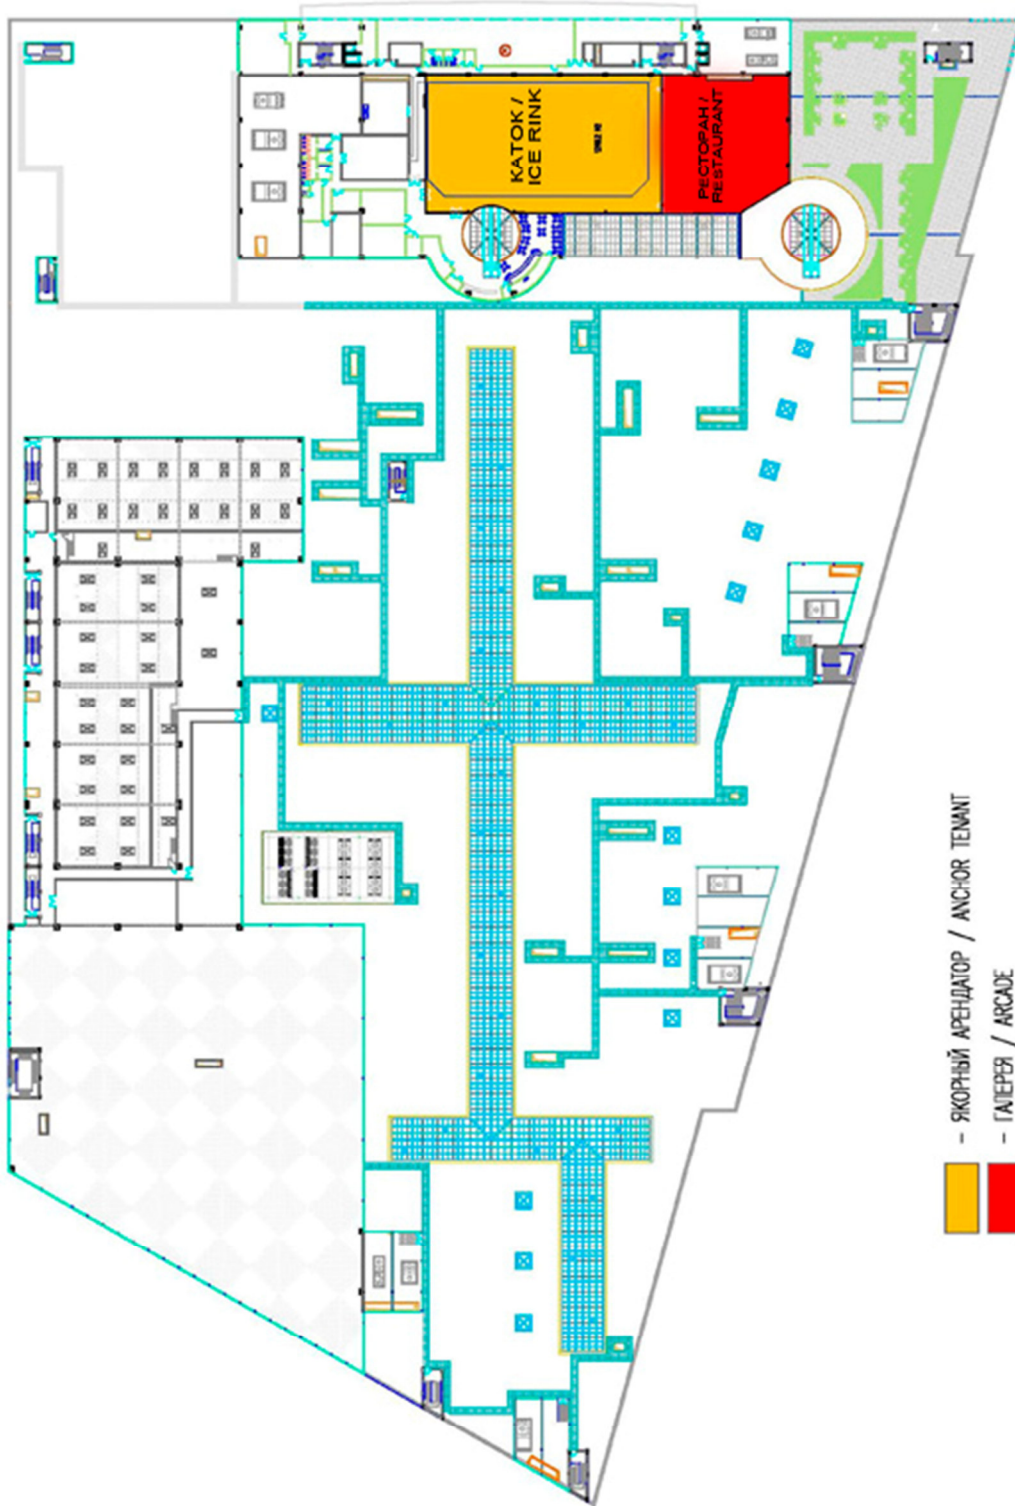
Общий план 3-го этажа ТРЦ «Парус» г. Москва
